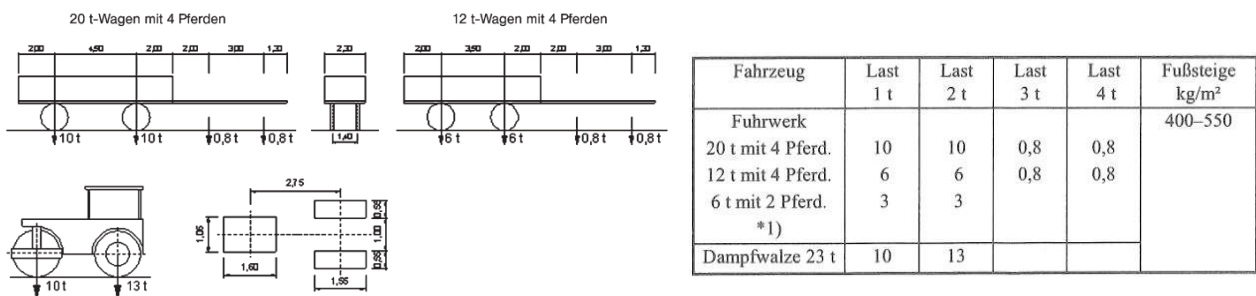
Lastschema für Straßenbrücken im Jahr 1910
